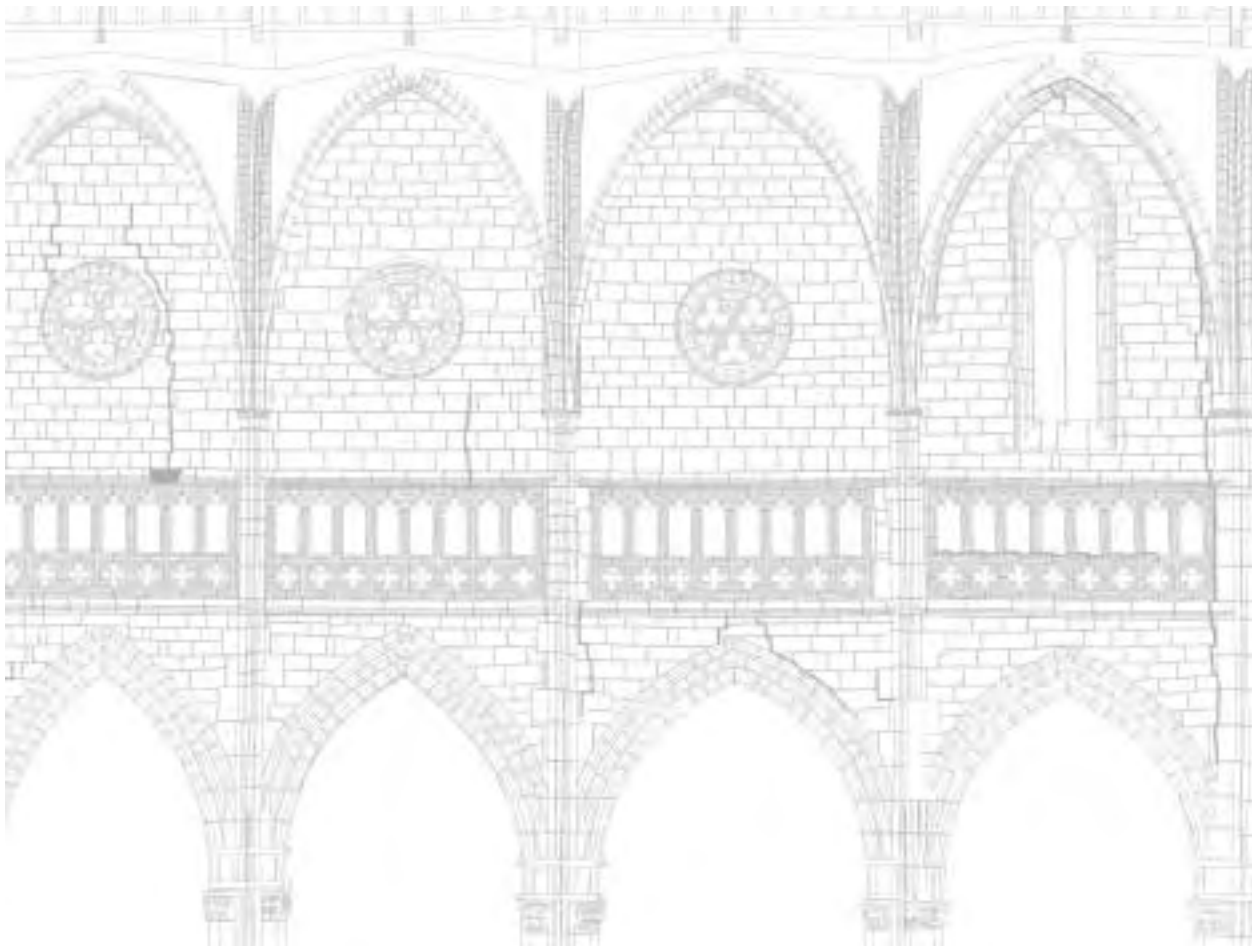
Sección nave central hacia norte. Fisuras
